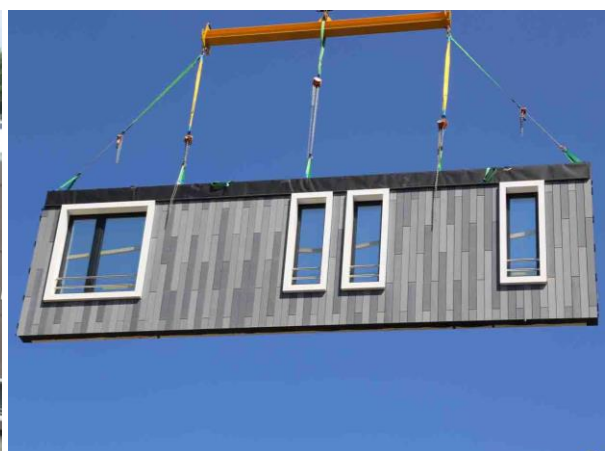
Baustelle BO - Montage der Holztafelelemente, [ACMS Architekten GmbH]
